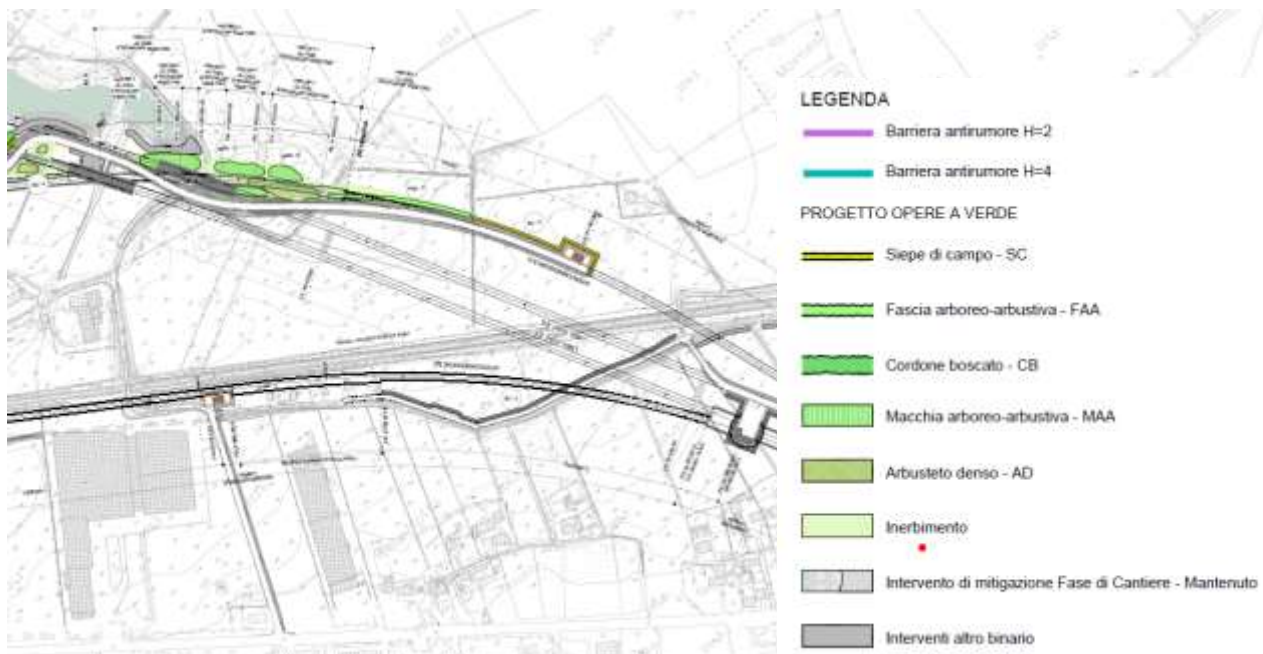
Progetto approvato – mitigazioni IAVB – Pianta
